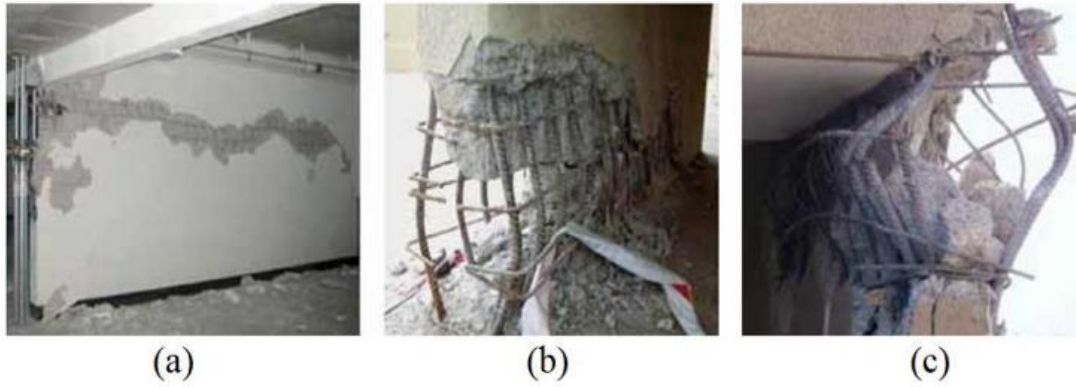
Daño en Muro de H.A, Pandeo y fractura de refuerzo
